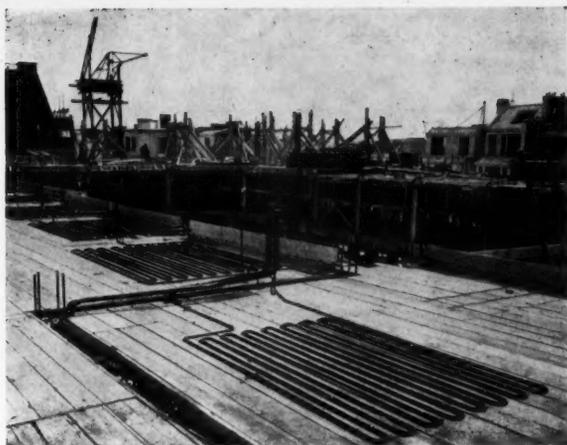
PANNEAUX (SERPENTINS) POSÉS SUR LE COFFRAGE DU CIMENTIER AVANT LA COULÉE DU BÉTON.
